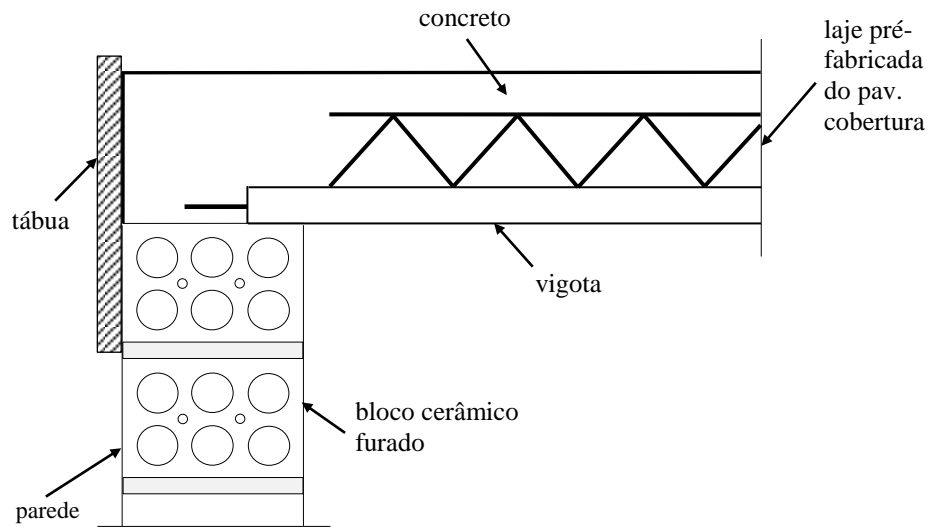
Ligação de laje da cobertura diretamente em parede de vedação.
